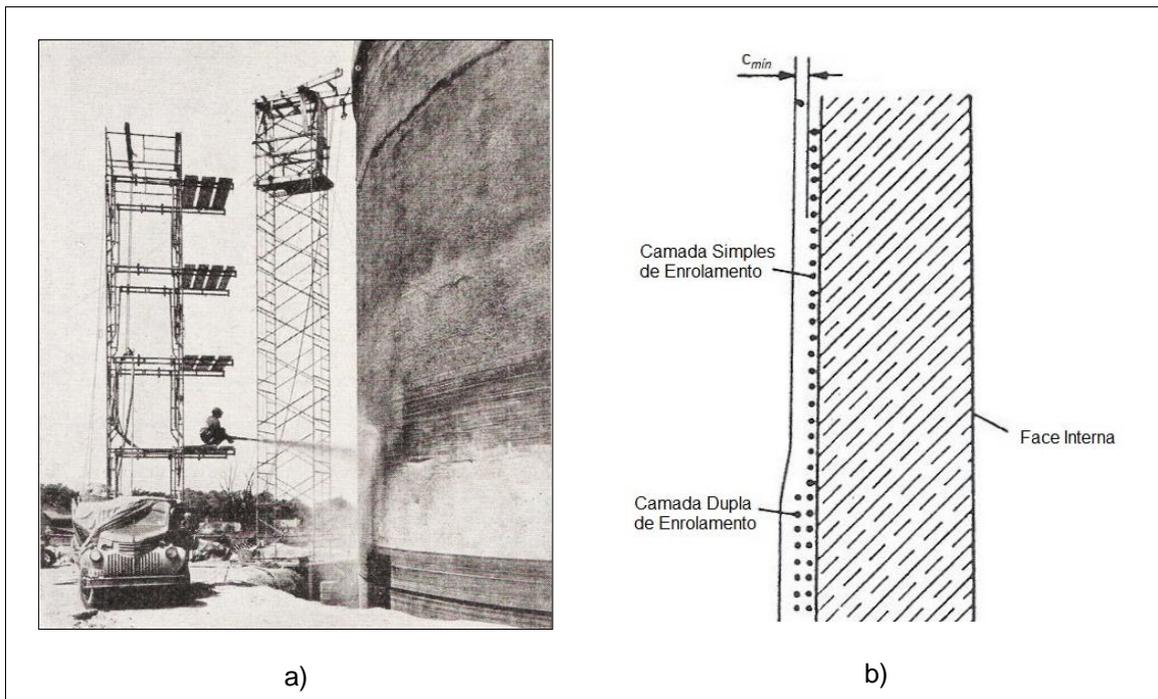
Equipamento utilizado para aplicação da protensão externa helicoidal: a) operação em tanque de 40m de diâmetro e 17m de altura; b) detalhe do equipamento (LEONHARDT, 1964).
